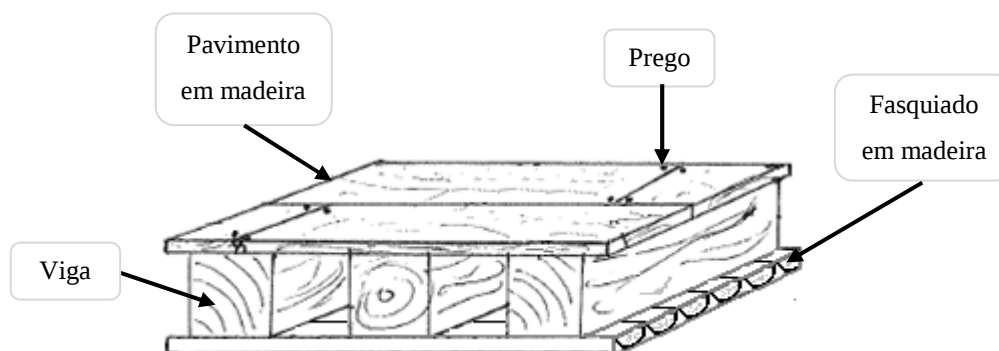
Esquema construtivo do pavimento em madeira com caixa-de-ar.
